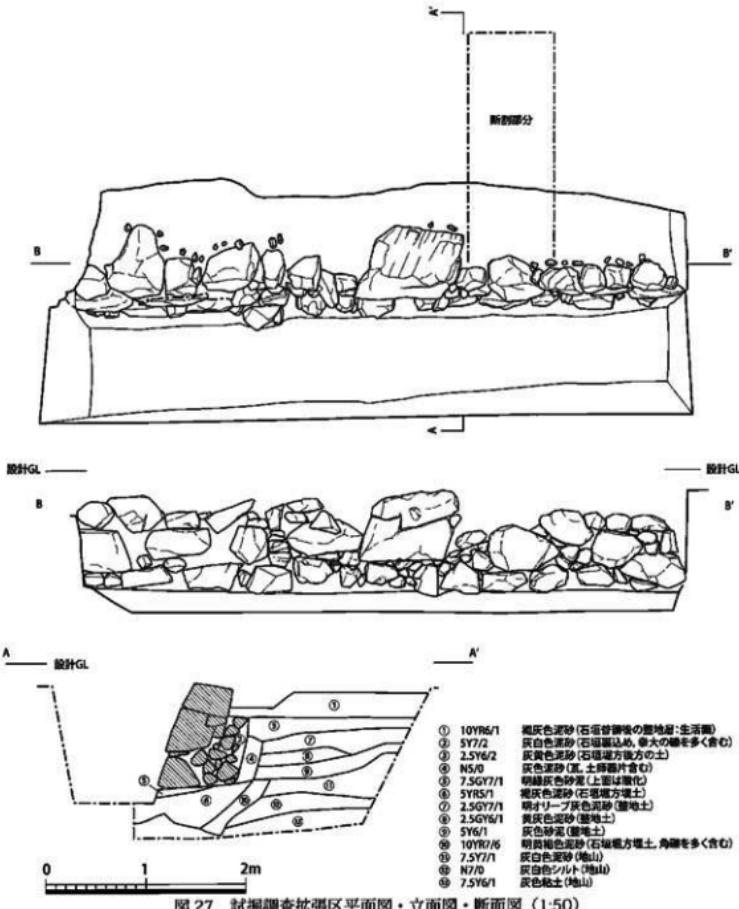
試掘調査拡張区平面図・立面図・断面図 (1:50)
